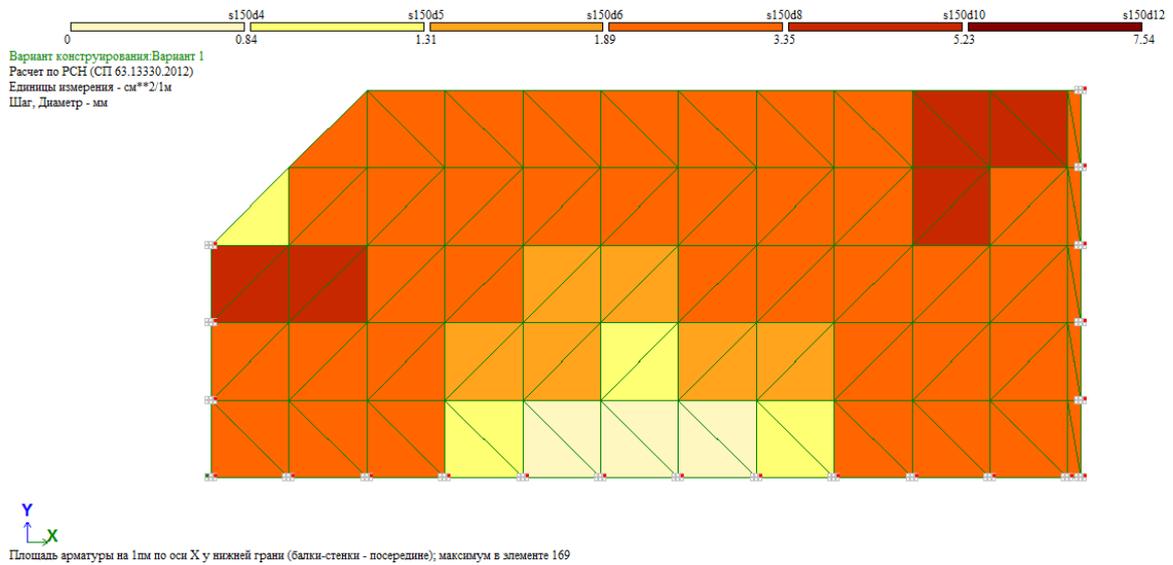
Площадь арматуры на 1 п.м. по оси X у нижней грани
